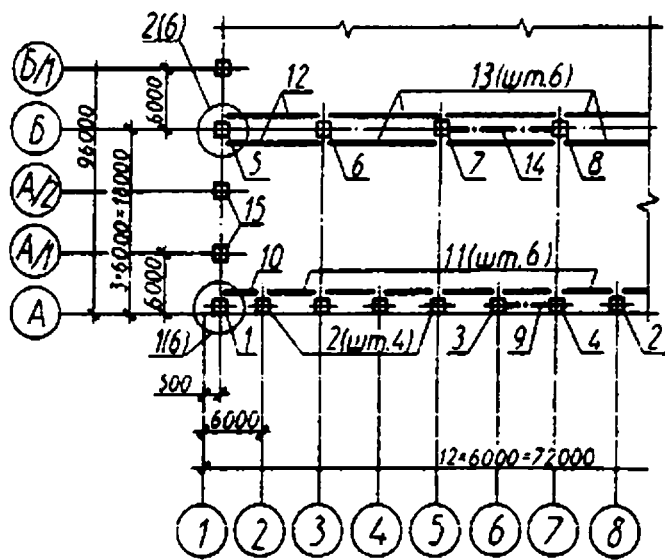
Пример схемы расположения колонн и подкрановых балок
